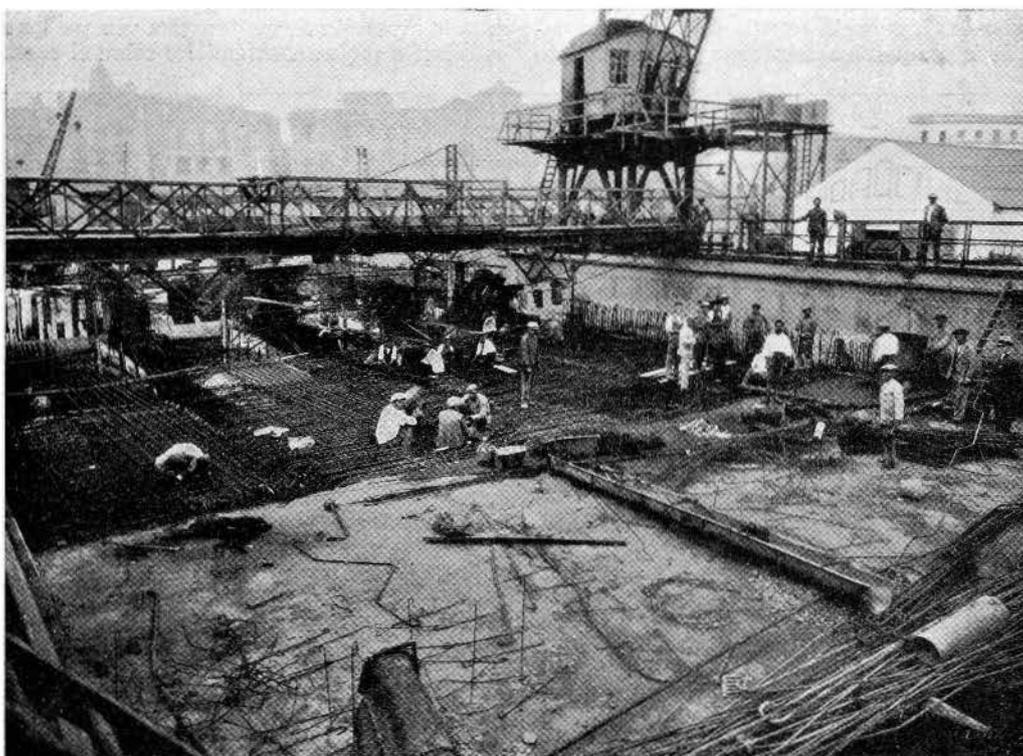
Otro aspecto del armado y hormigonado del techo del cajón
